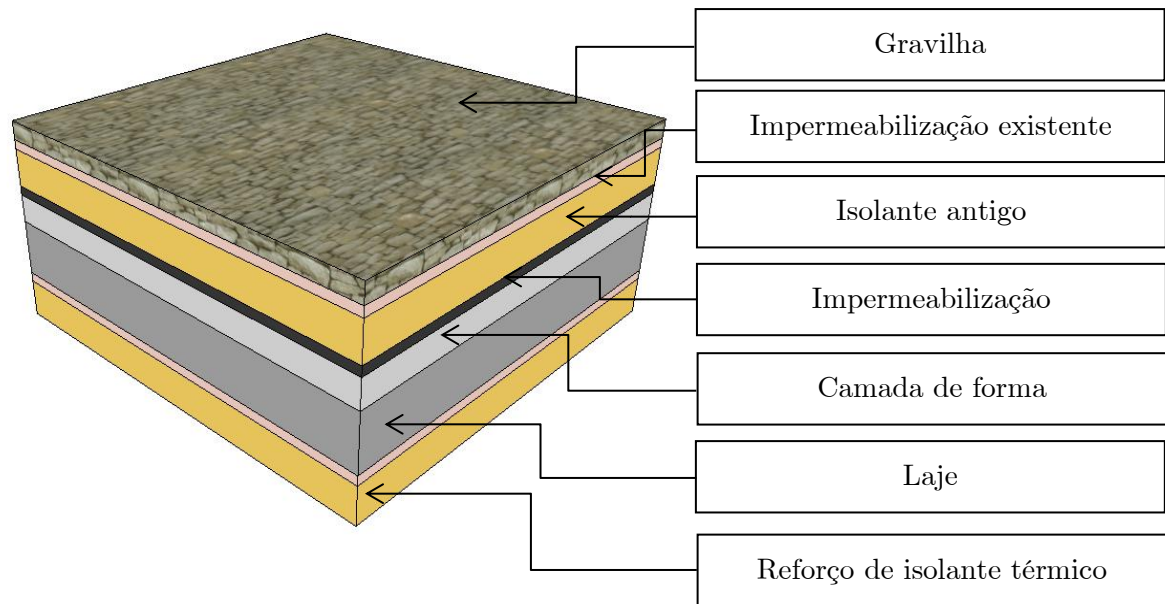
Esquemática de um sistema reforço térmico em coberturas horizontais em terraço
